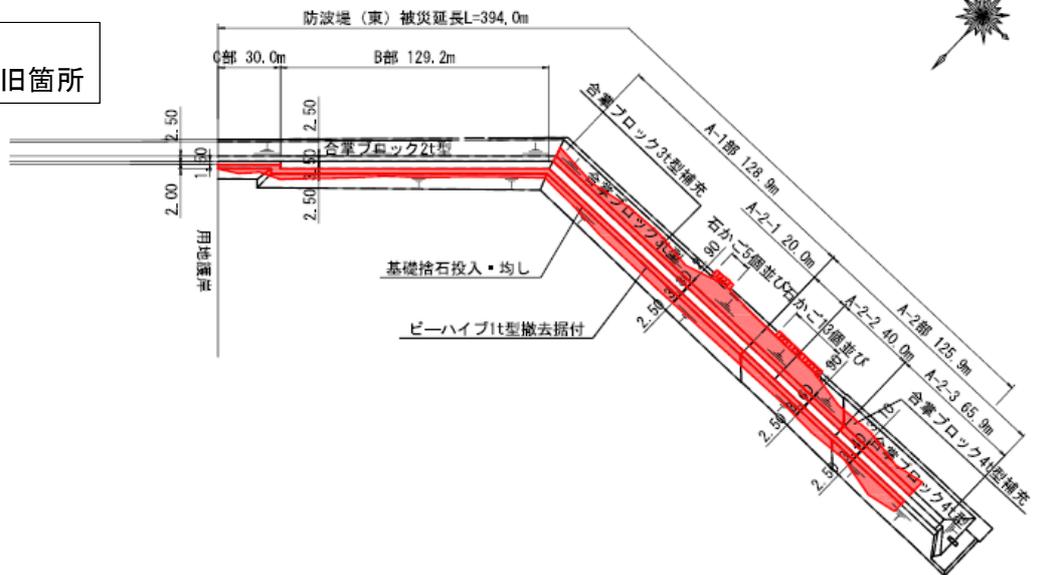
No.1 防波堤（東）の平面図（復旧後）
